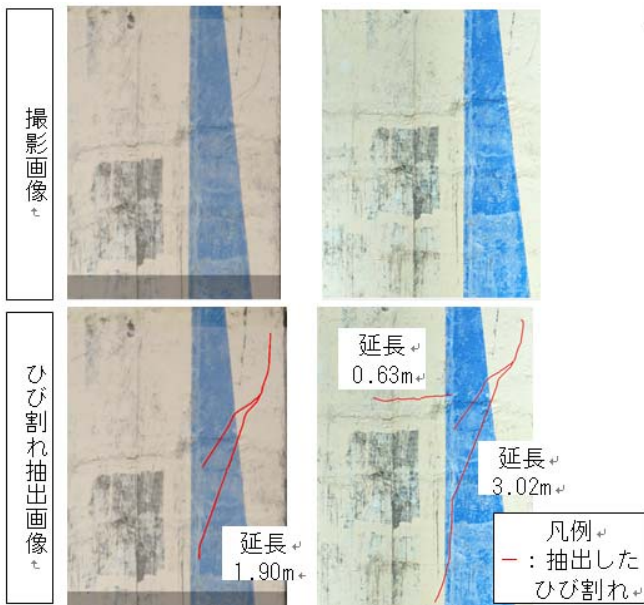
ひび割れの比較(左:地上画像、右:空撮画像)
